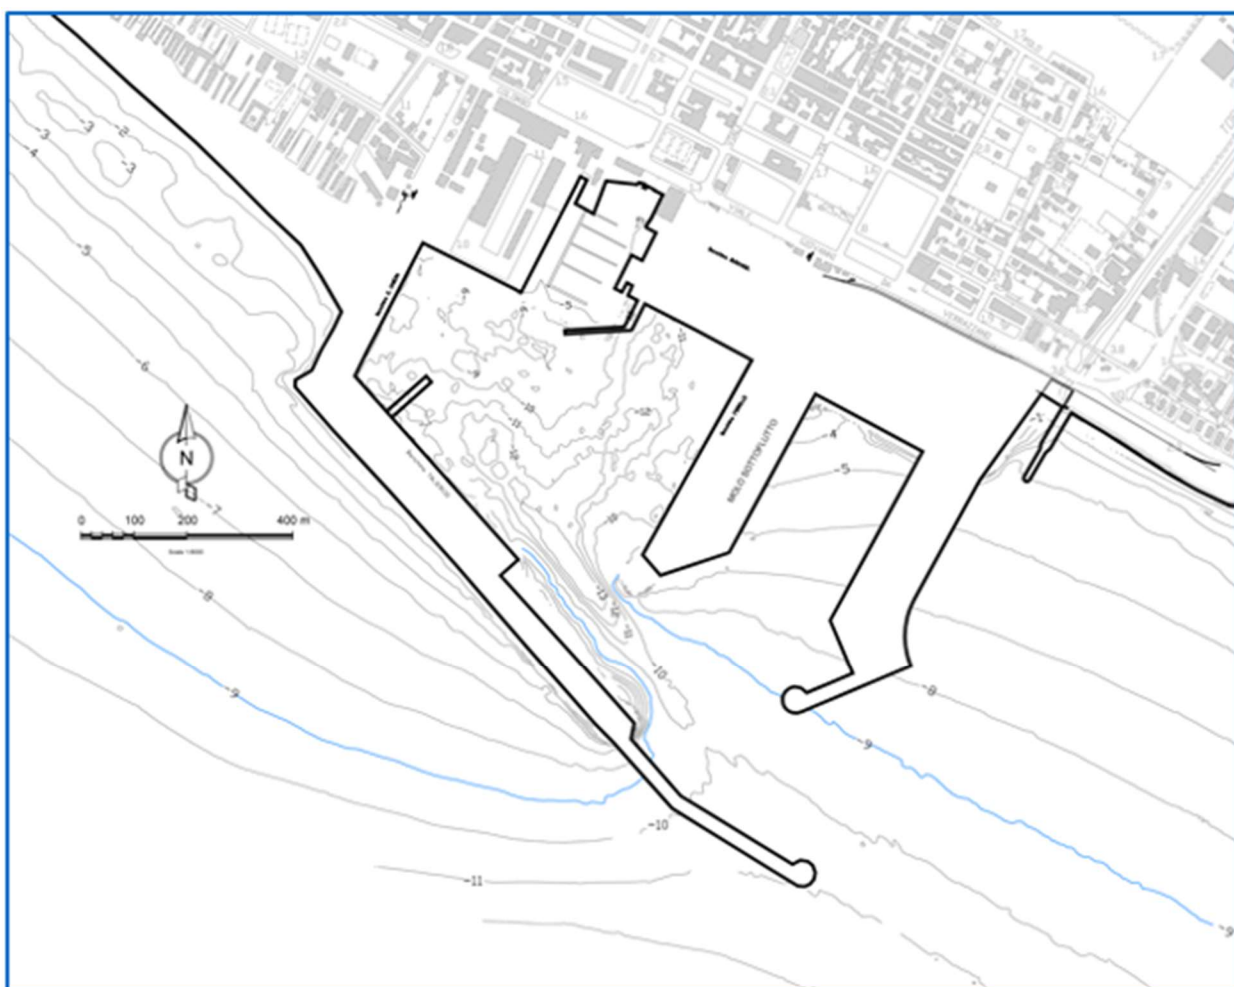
Planimetria della Configurazione Portuale Definitiva.
